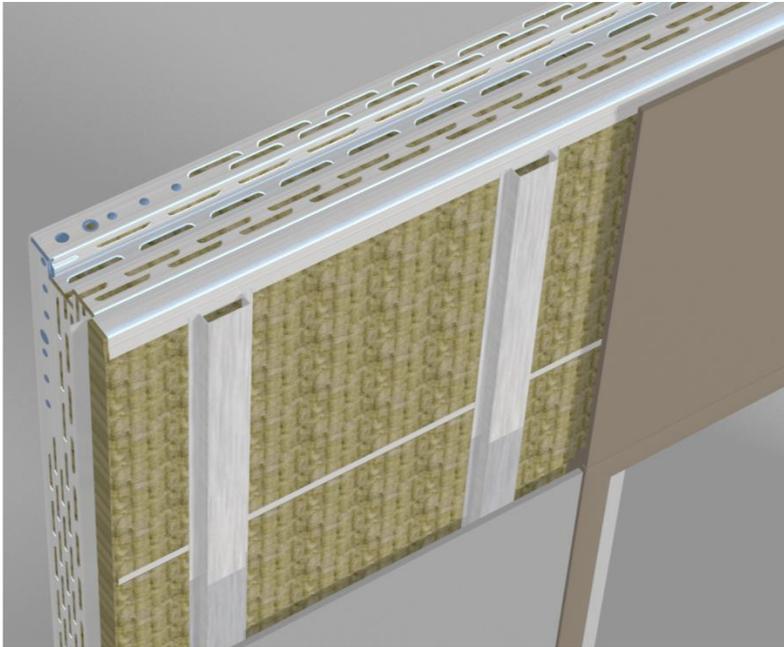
Visualización 3D del panel con capa de aislamiento térmico adicional y sistema de fachada ventilada. Fuente: Elaboración propia.
